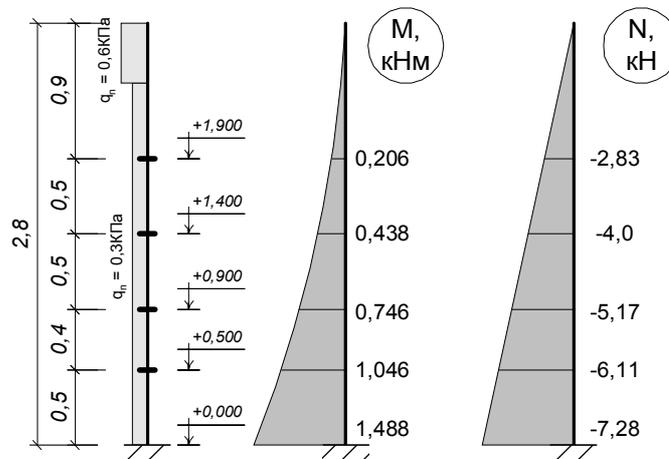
Расчетная схема кирпичной стены, эпюры изгибающих моментов и продольных усилий от ветровой нагрузки (ветер слева) и собственного веса
